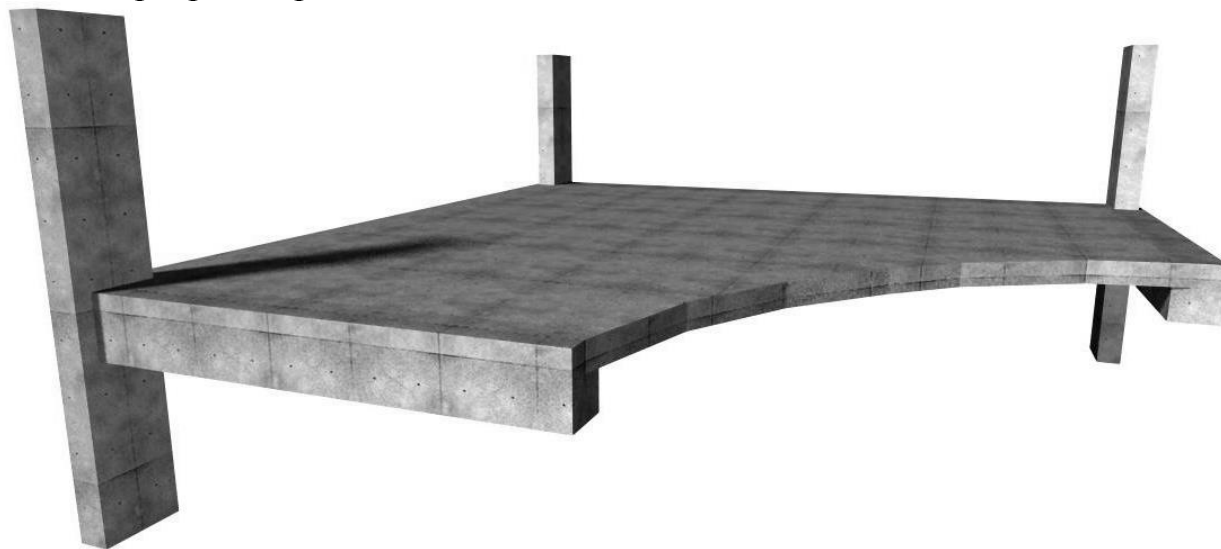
Вариант-1 расчетной схемы. Сплошное перекрытие сечением 160 мм
